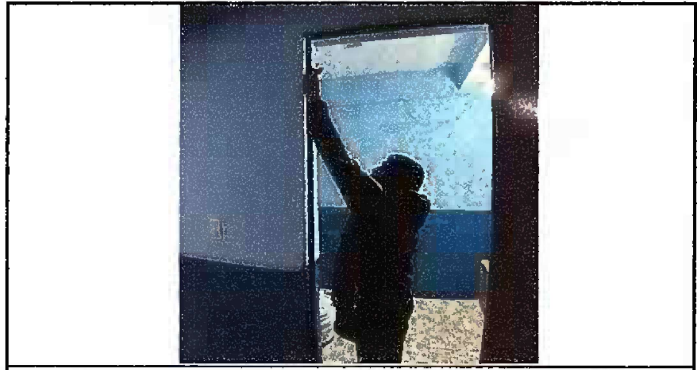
Módulo 2 (Planta alta y baja) - Mantenimiento a estructura de puerta (lijado, cambio de tubo, cepillado, sujeciones, aplicación de pintura).
